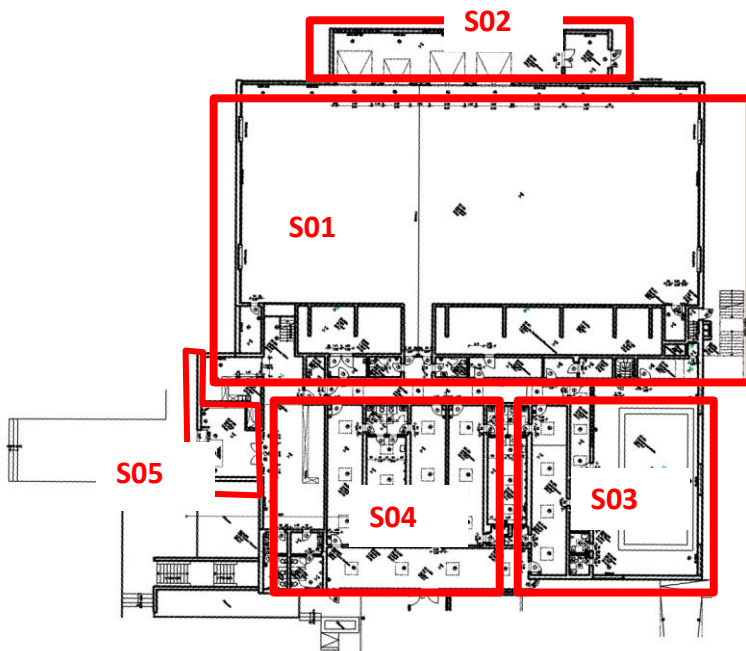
Grundriss Erdgeschoss Sporthalle
